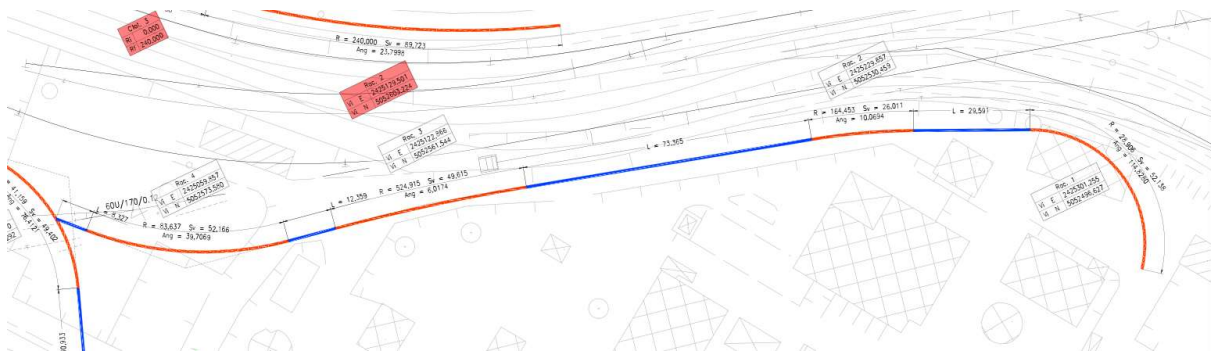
Andamento planimetrico dell'asse stradale - Svincolo in direzione dell'area ARVEDI.
